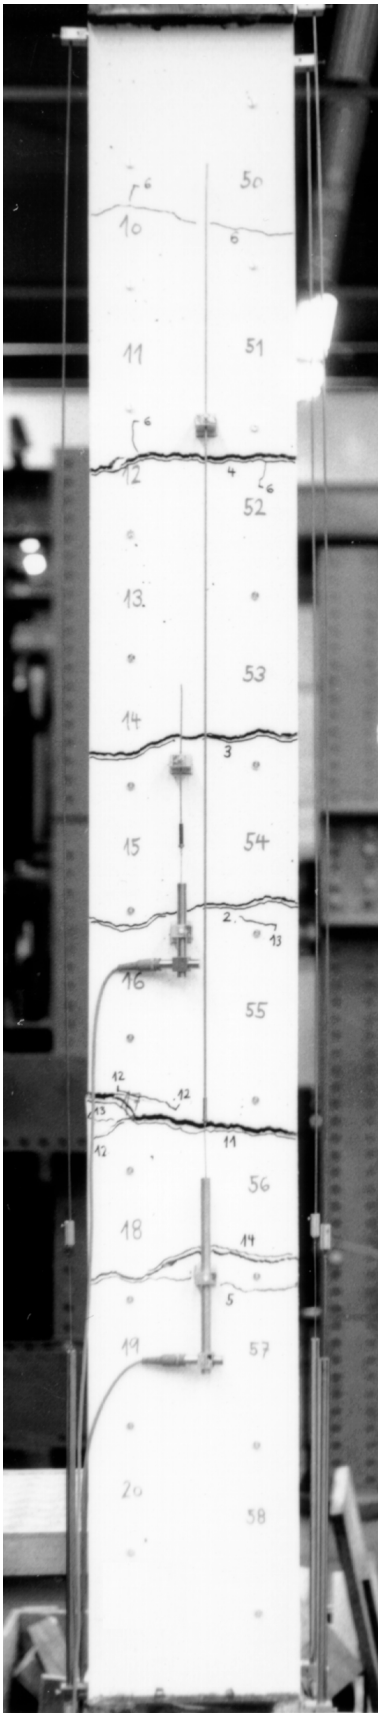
T75.0: Rissbild bei Laststufe 13.
